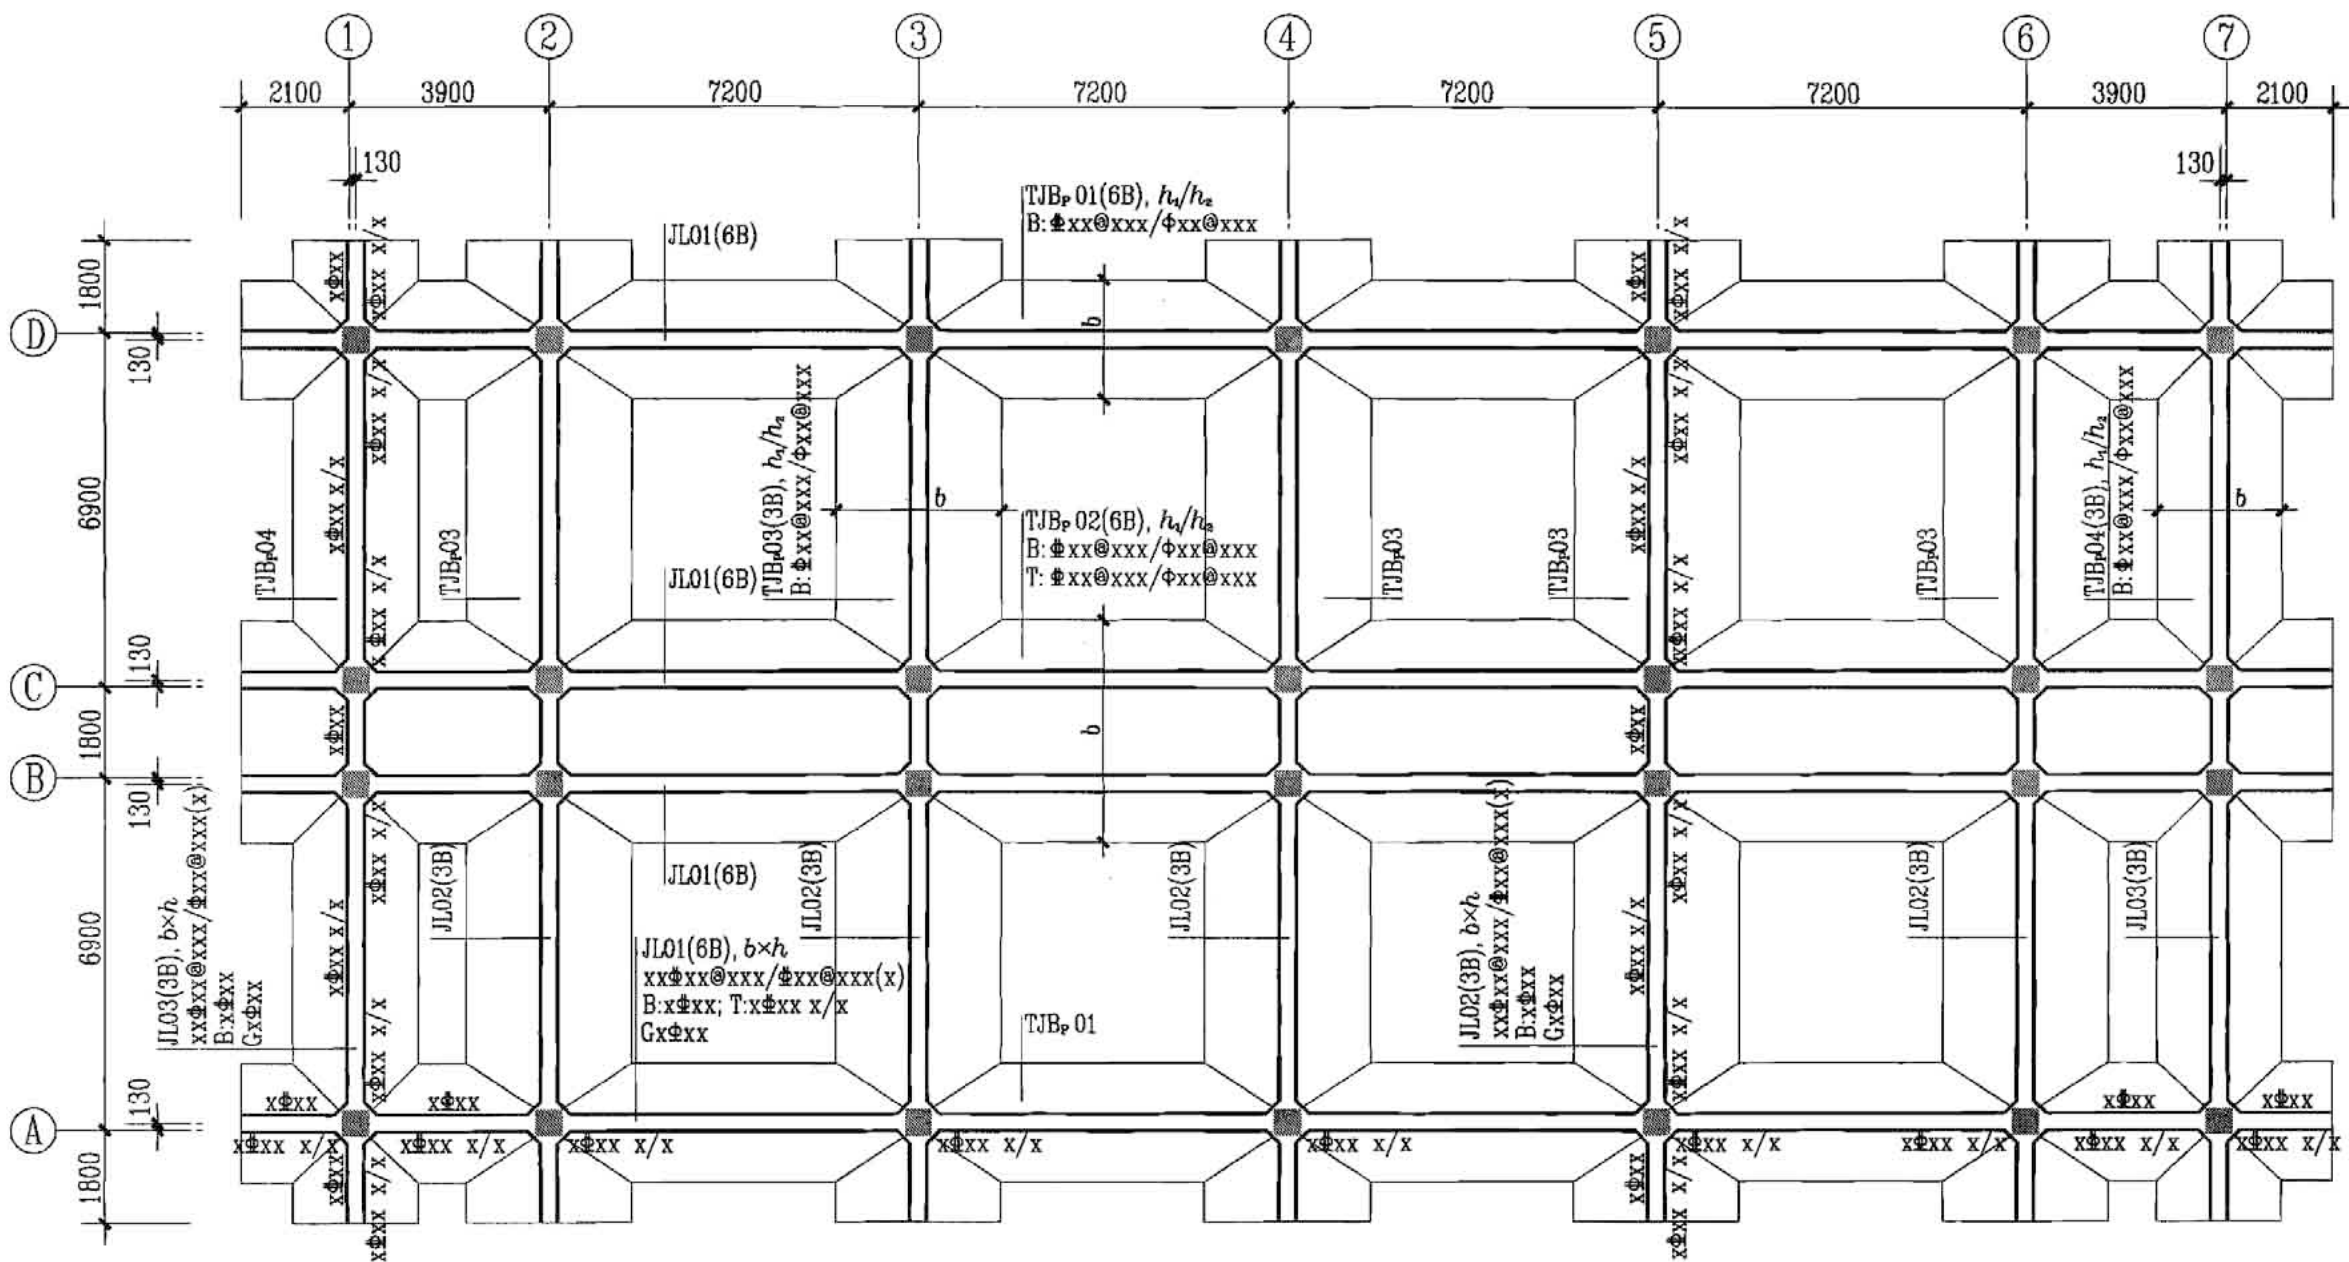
采用平面注写方式表达的条形基础设计施工图示意
